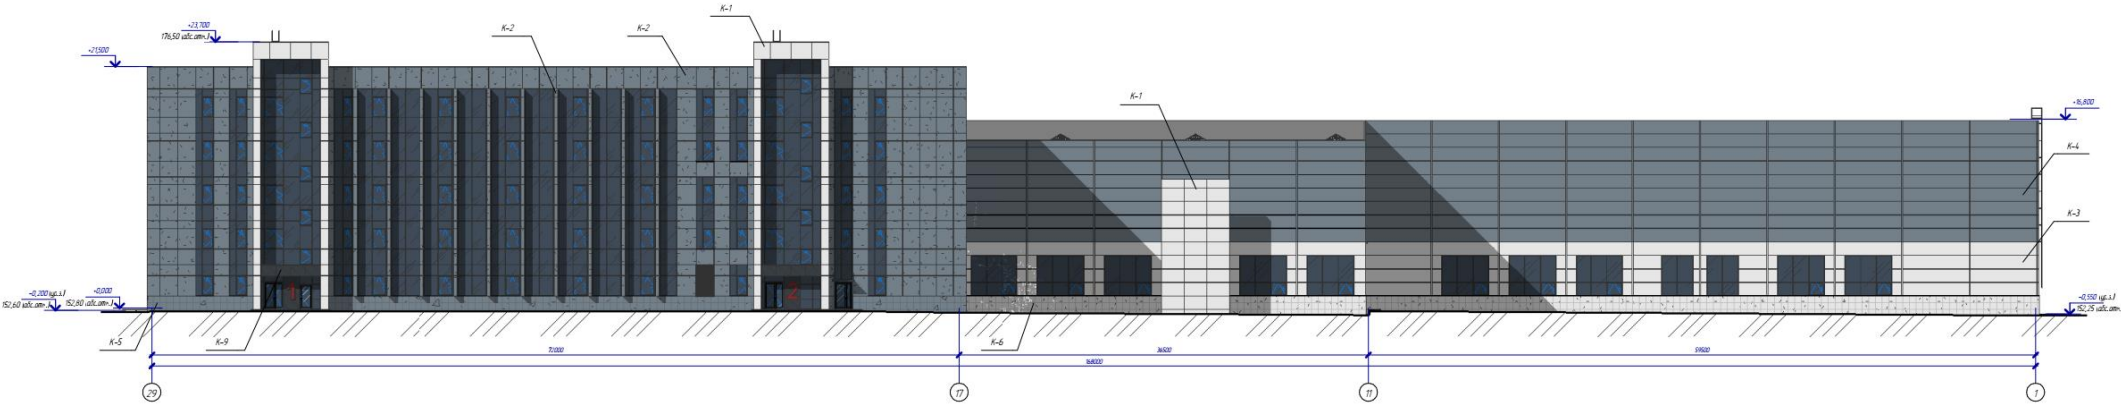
Схема фасада по оси 29-1 (фронтальный вид)
